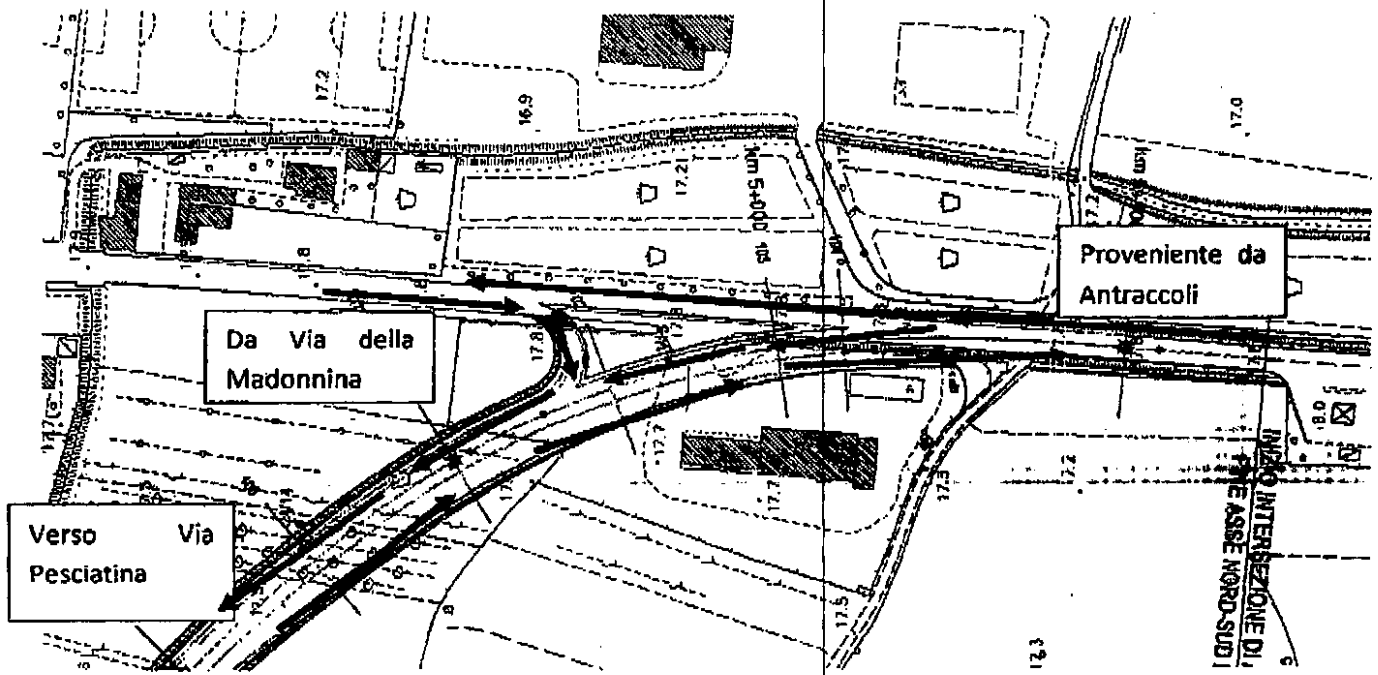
Estratto Tavola T00 PS01 STD PF03 Asse Nord – Sud, Planimetria di Progetto Tav 3/3
